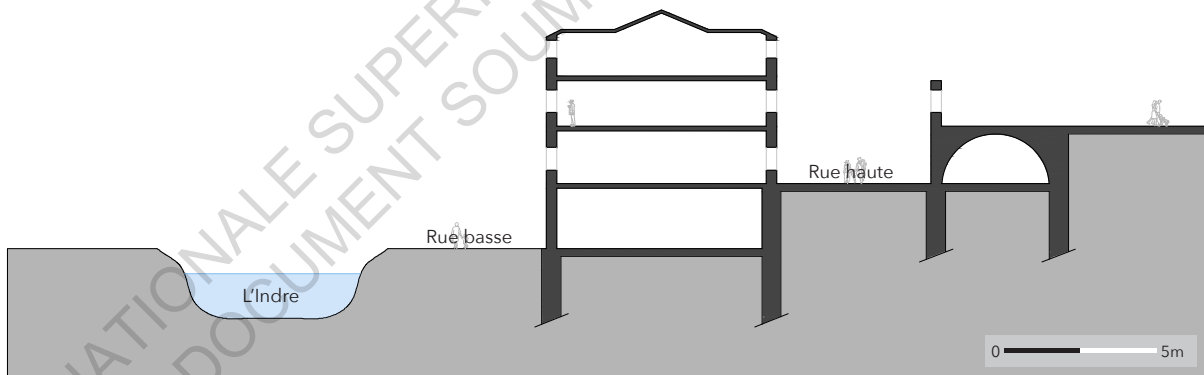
Coupe BB située à l'Est du bâtiment du Flockage
